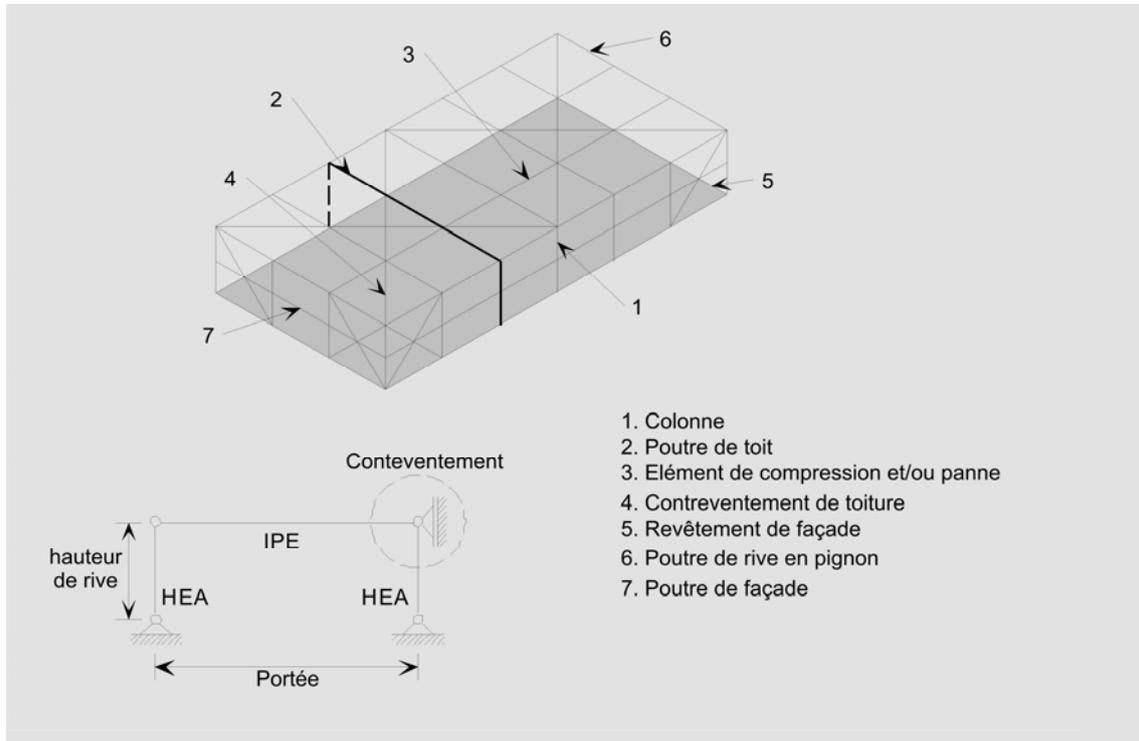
Structure classique poteaux-poutres avec assemblages articulés
